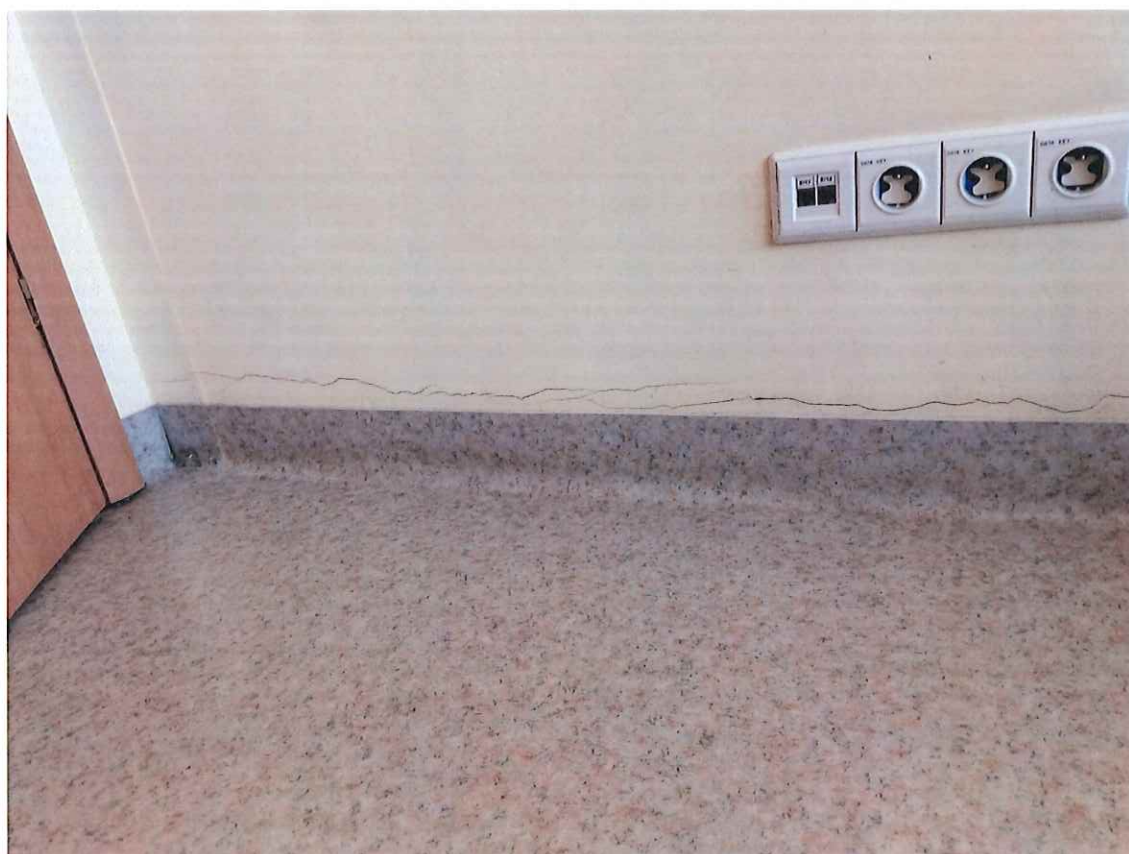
Zarysowanie ściany przy drzwiach pomieszczenia P113 (rozwartość rysy 1,5mm)
